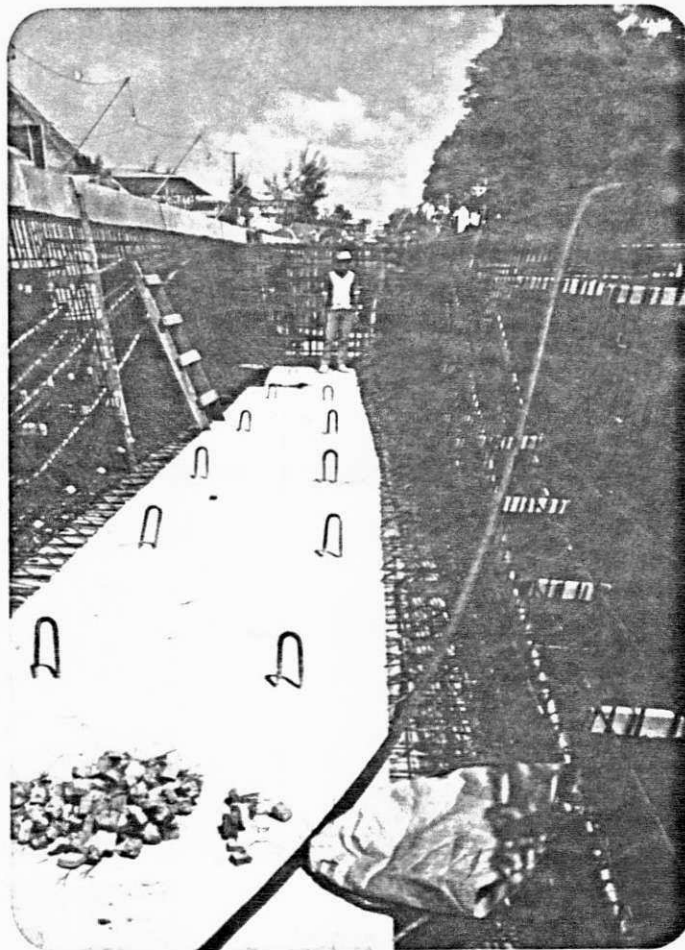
Vista da laje inferior do trecho I - Pista Esquerda já concretado, destacando-se as bainhas de protensão nas vigas laterais.
